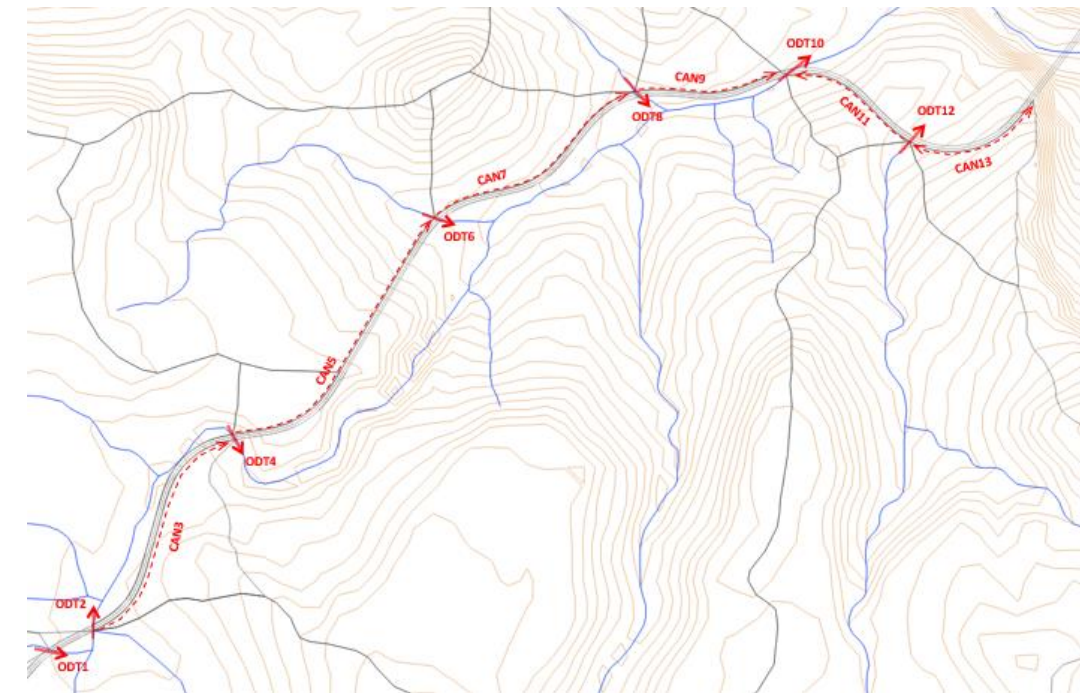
Zona sur. Drenaje longitudinal y transversal. Alternativa 2
